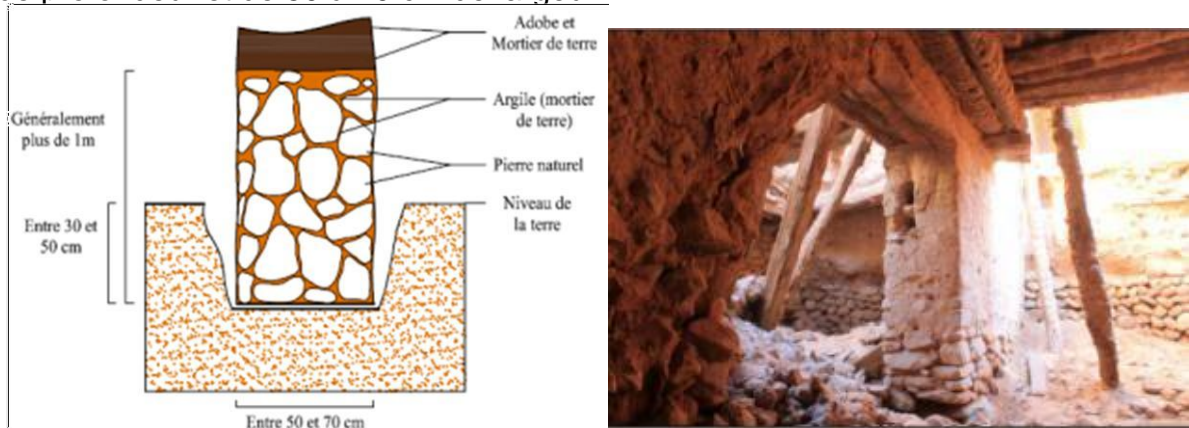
Tranchés de fondations en pierre naturel Echelle 1/25
